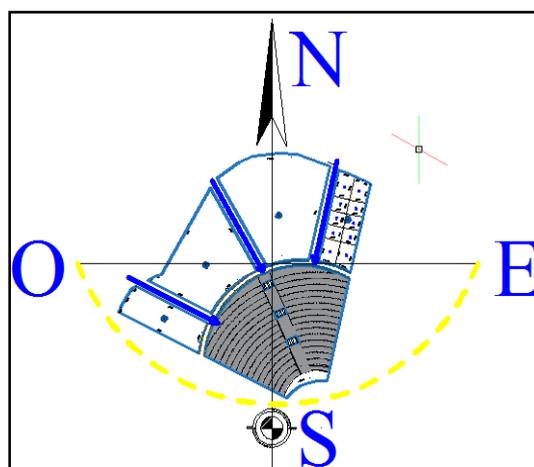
Asoleamiento zona 3 Condor Pasa.
